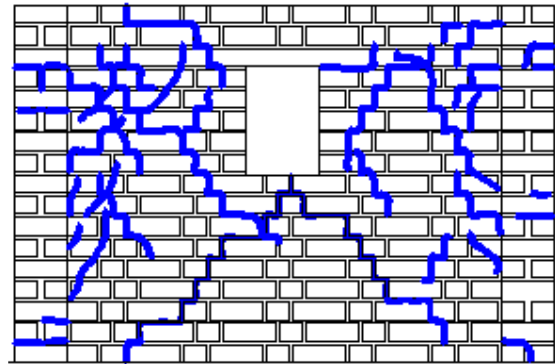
Levantamiento de fisuras del muro con geomalla (Madueño I.)
